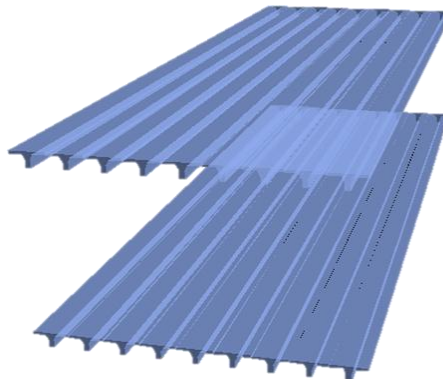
Modelado de sistema de losa de vigueta y bovedilla.
